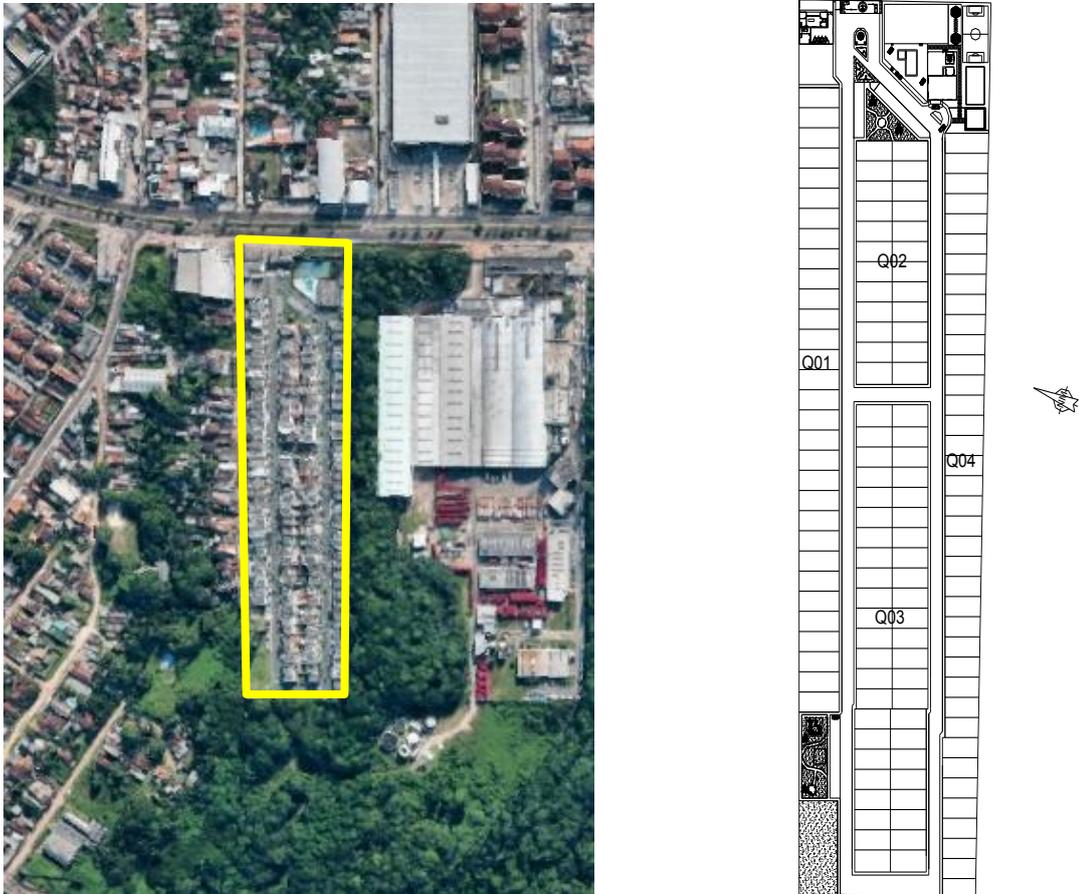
Condomínio Cidade Jardim I – Vista aérea e planta baixa
